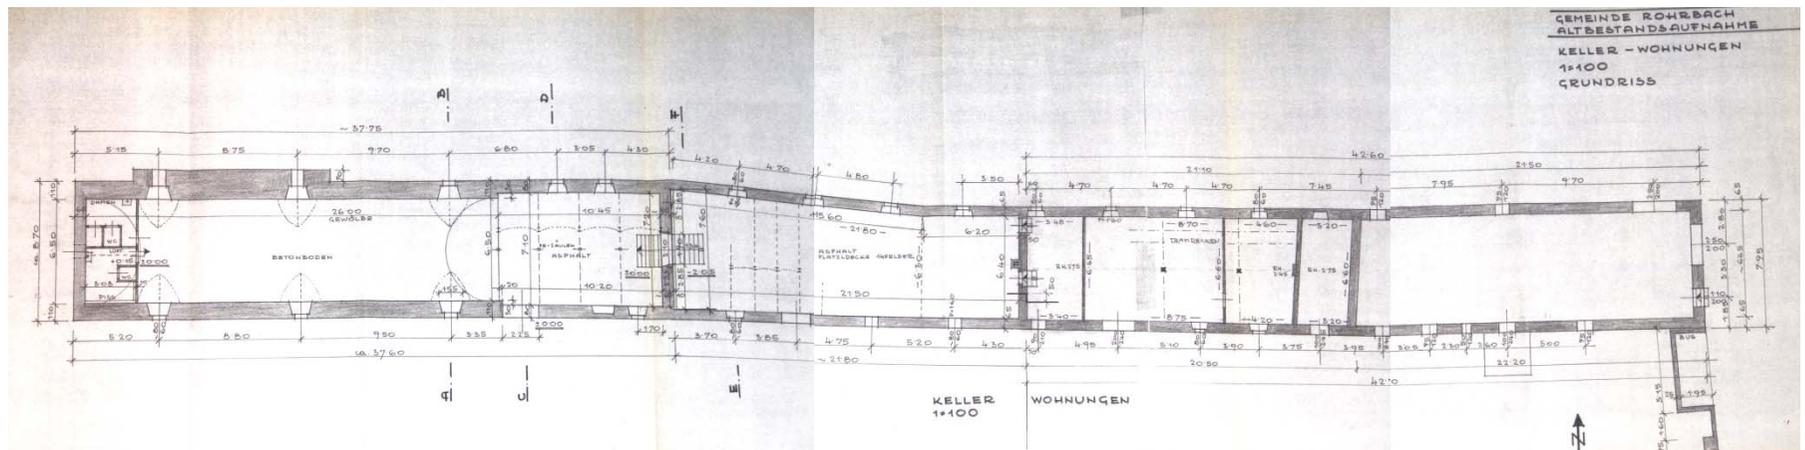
Bestandsaufnahmeplan Fürstenkeller und Wohnungen, Erdgeschoss, undatiert
